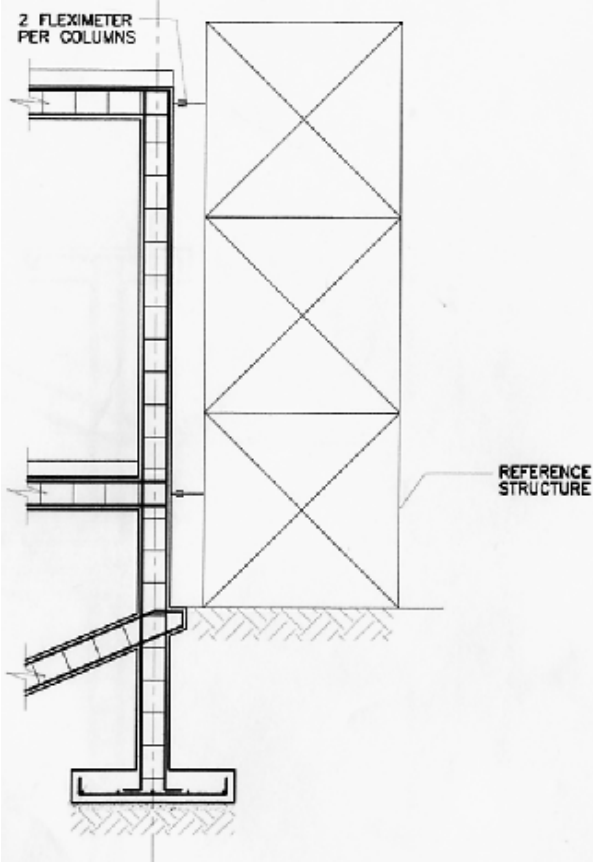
Detalle de la Viga de Carga y Armazón para Medición
